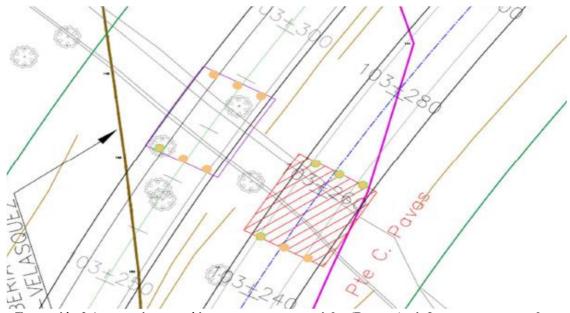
Acercamientos críticos con estructuras viales (Puentes) e infraestructura petrolera
